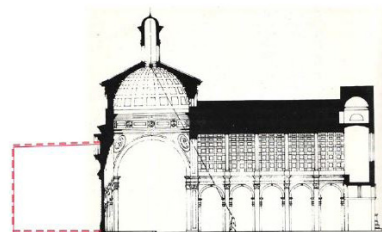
Reconstituição do corte e planta da Igreja de *San Satiro*. O tracejado indica o tamanho aparente da ábside.
